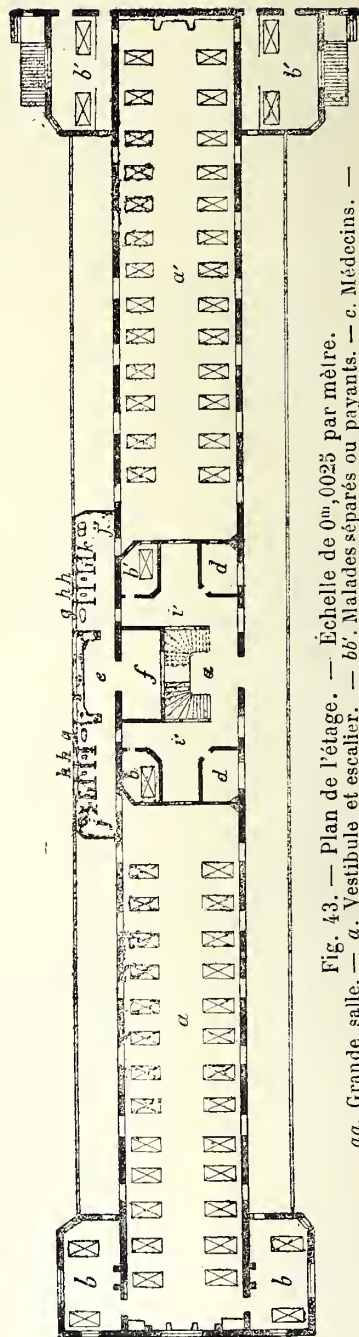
Plan de l'étage. — Échelle de 0m,0025 par mètre.
